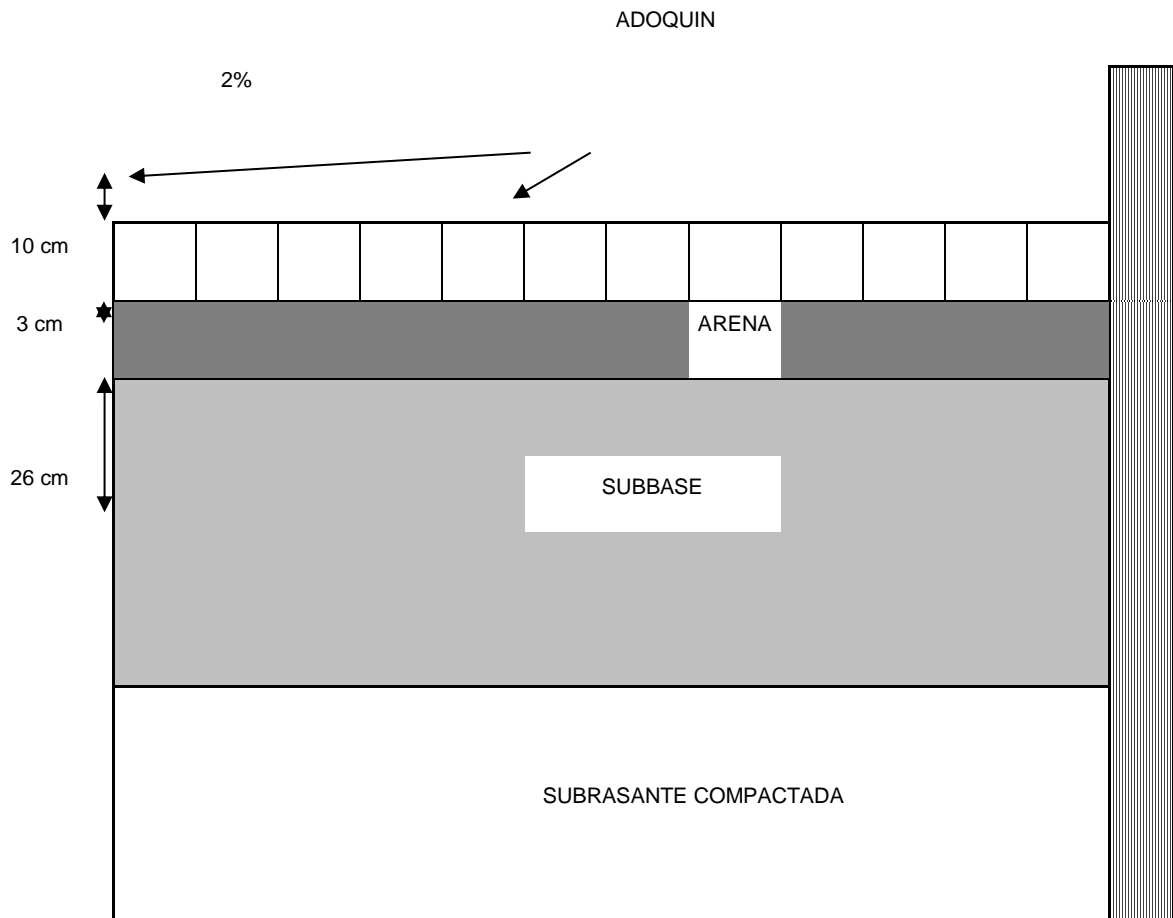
Resumen del Cálculo de Espesores para pavimento flexible, Modificado (Elaboración propia).
